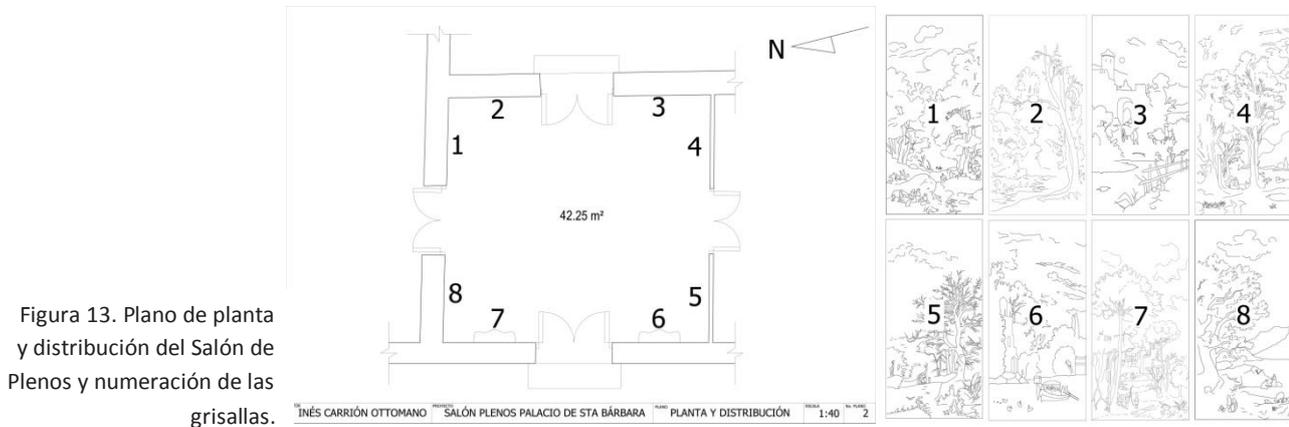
Plano de planta y distribución del Salón de Plenos y numeración de las grisallas.
